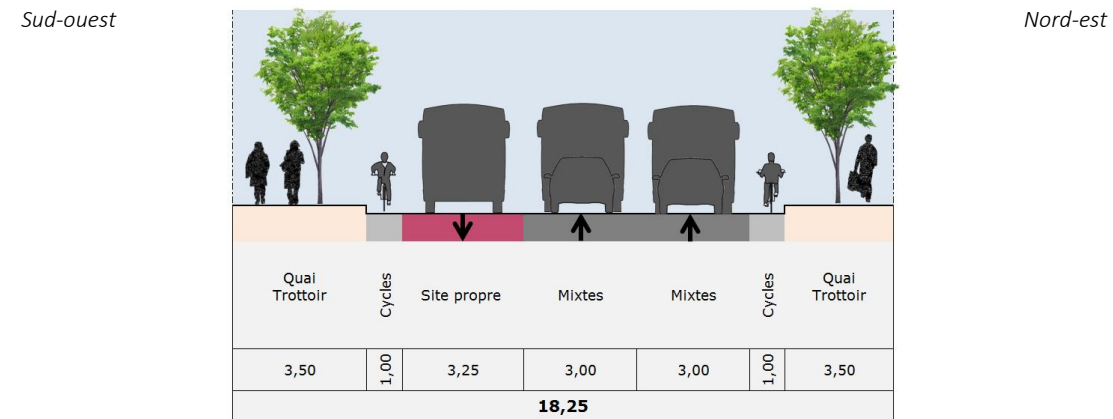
Coupe type sur le boulevard Maurice Berteaux - Variante 1
